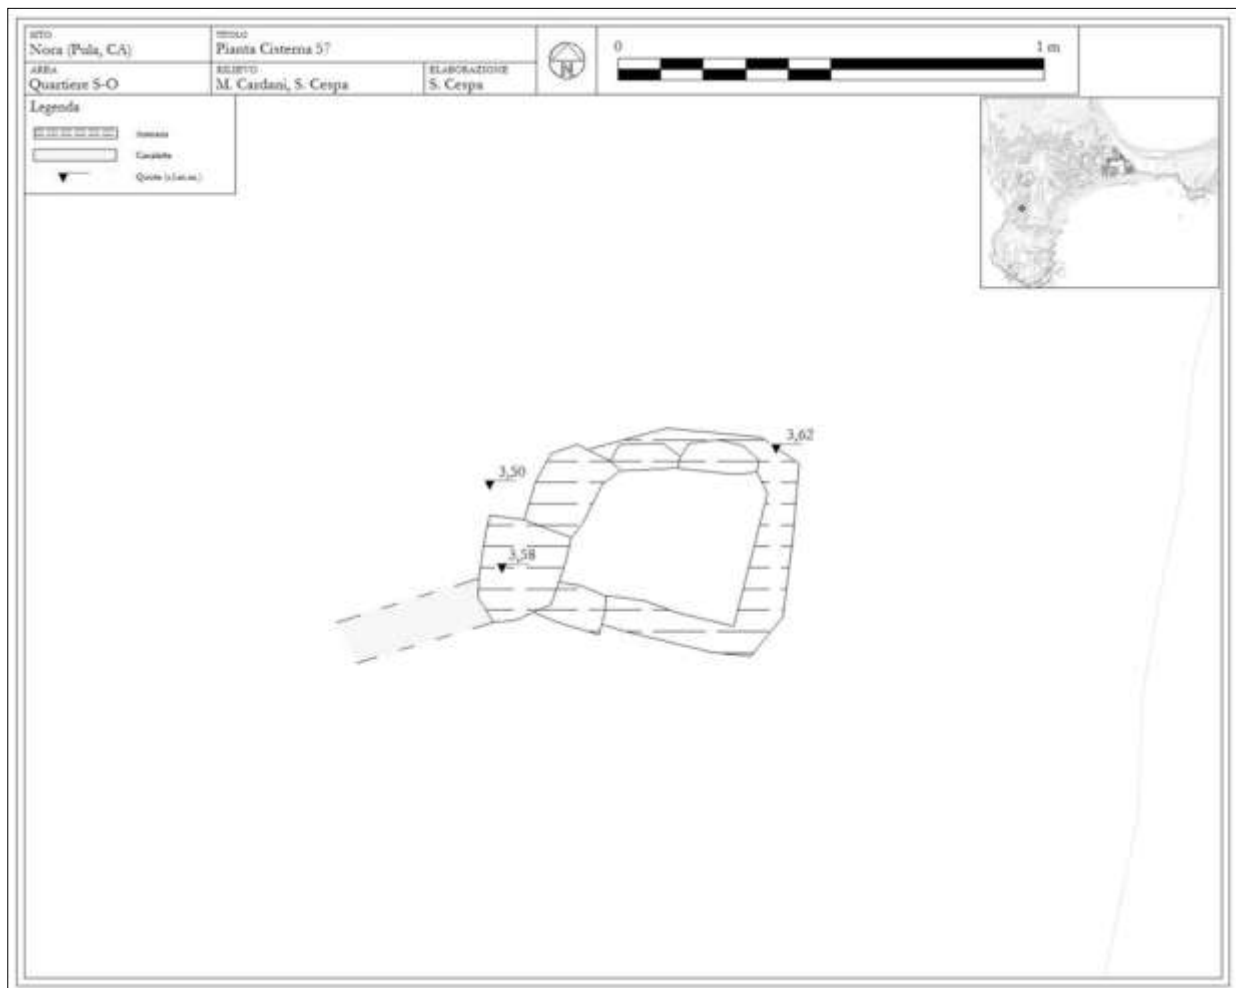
Pianta del pozzo/cisterna 57 (elaborazione dell'autore).
